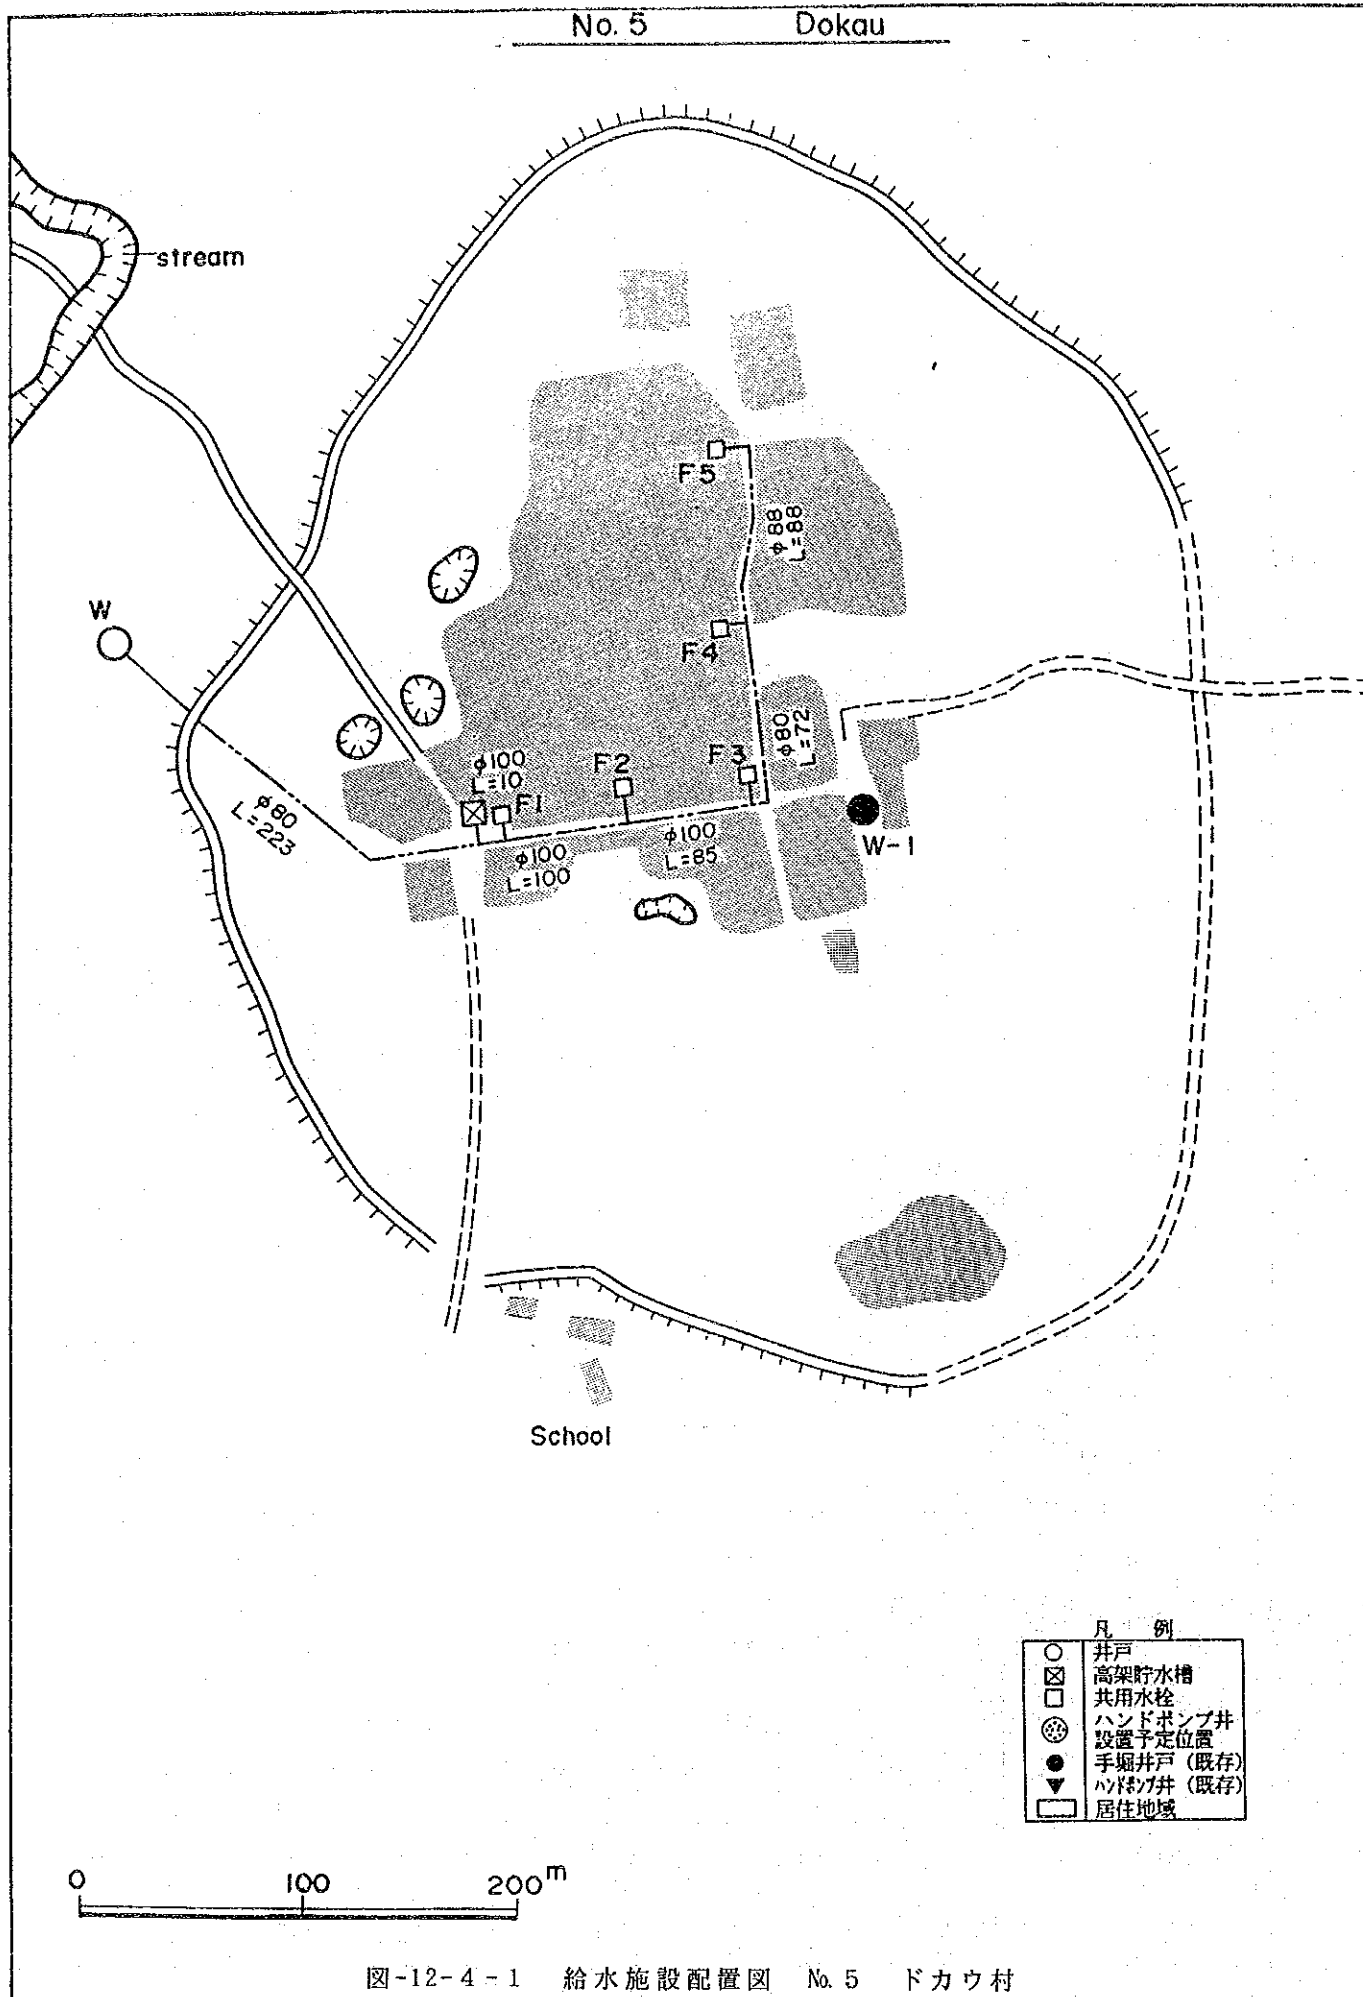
給水施設配置図 No. 5 ドカウ村
